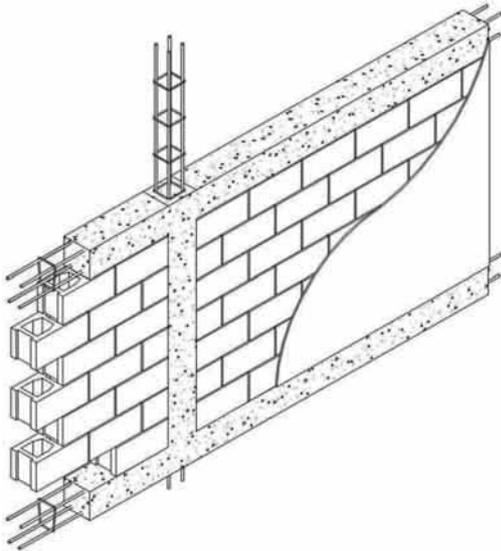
Muros de bloque de hormigón confinados entre pilares y vigas de hormigón armado.
